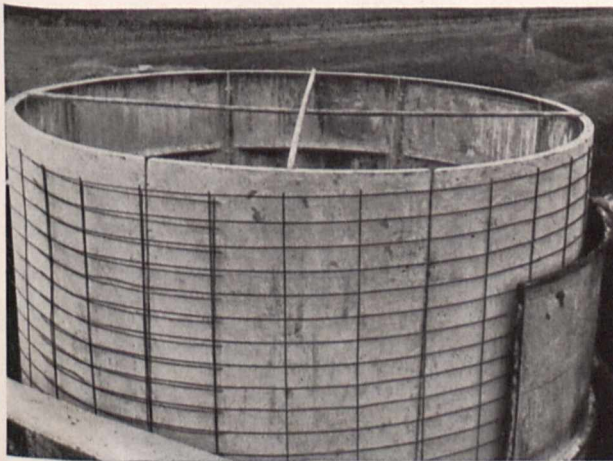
Armierung aus Baustahlgewebe bei einem Grünfütter-Silo
